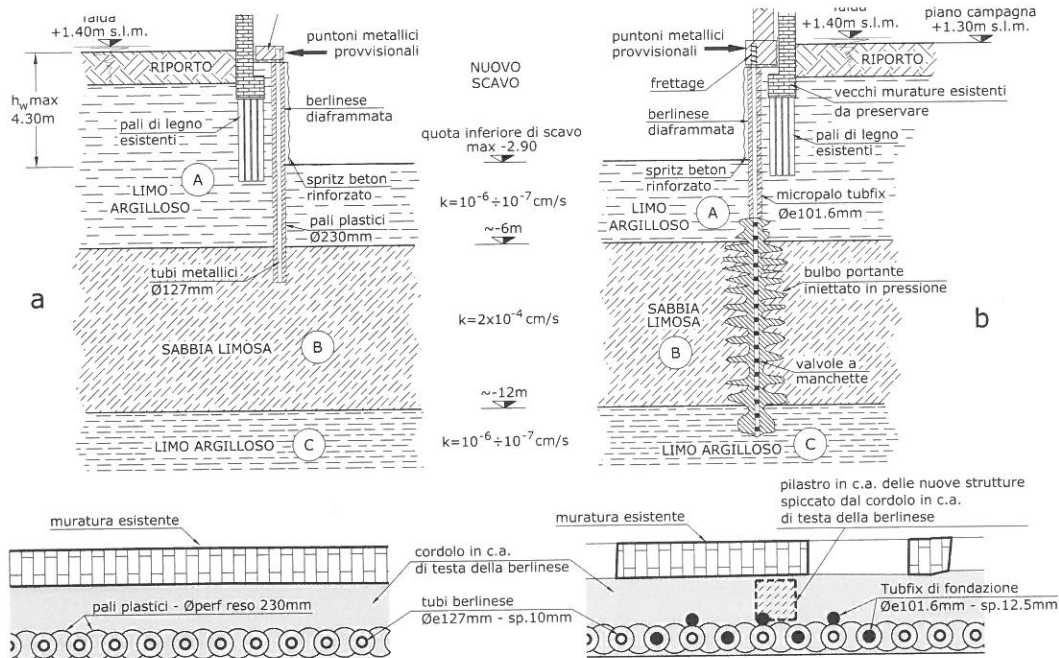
Planimetrie e sezioni tipo della berlinese diaframmata. A sinistra la berlinese corrente (a). A destra la berlinese con i tubfix di fondazione (b).
